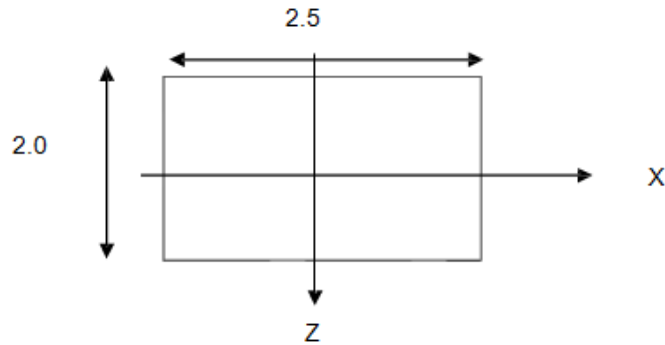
Dimensiones en planta de zapata Z-7.
